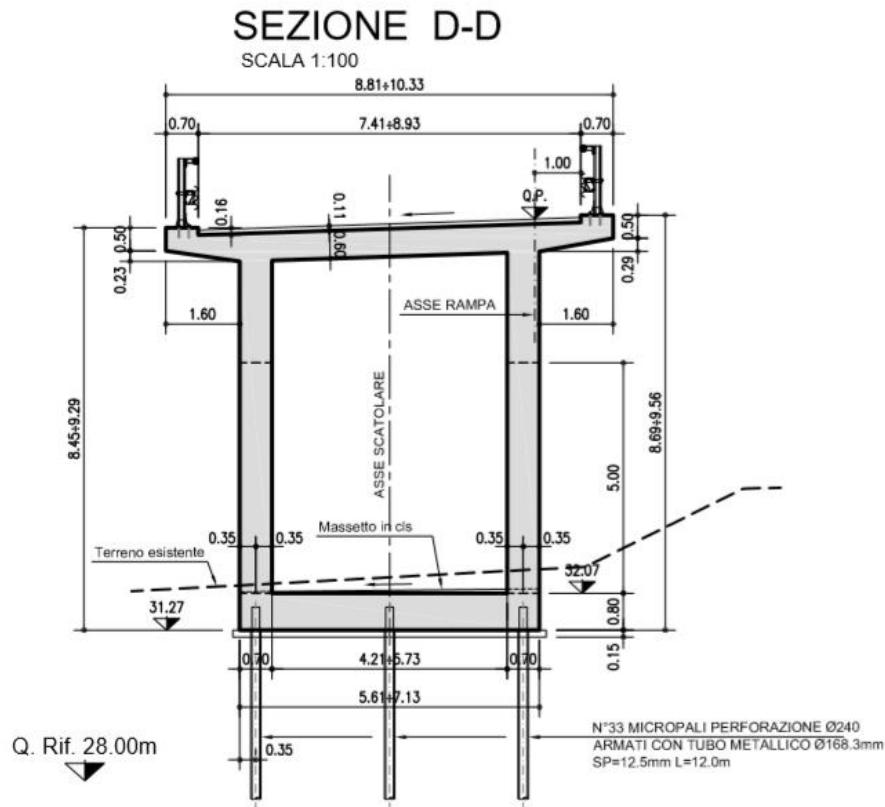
sezione trasversale nella mezzeria dello scatolare
